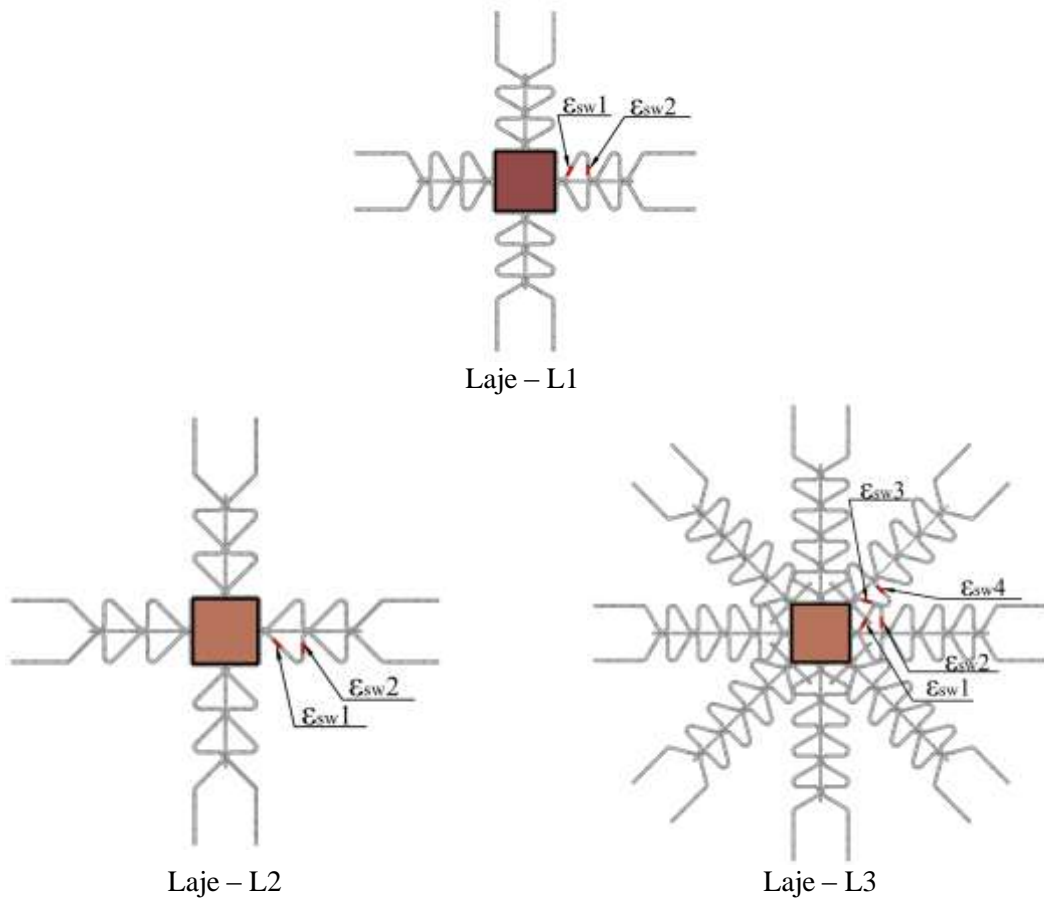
Arranjo e identificação dos extensômetros nas armaduras transversais.
